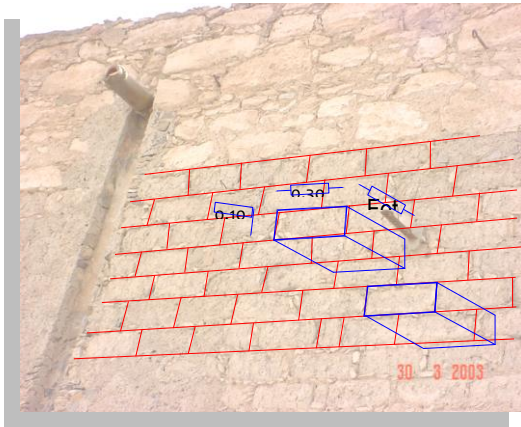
Vista de muro de 60 cm. perteneciente a las crujías norte como parte de la fachada exterior. Nótese la presencia de rajueado de piedra en las boquillas
